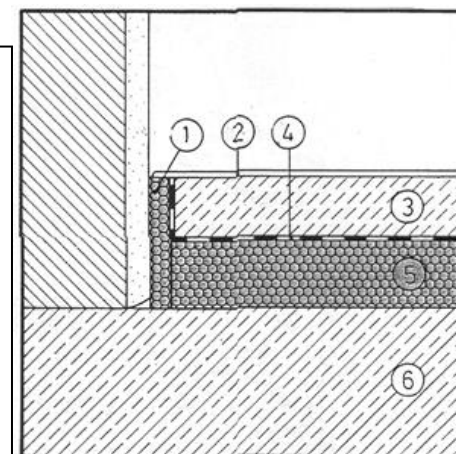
Particolare di pavimento galleggiante - 1: striscia laterale di PSE elasticizzato - 2: rivestimento calpestabile - 3: massetto in cls - 4: separatore - 5: lastra di PSE elasticizzato - 6: soletta.
